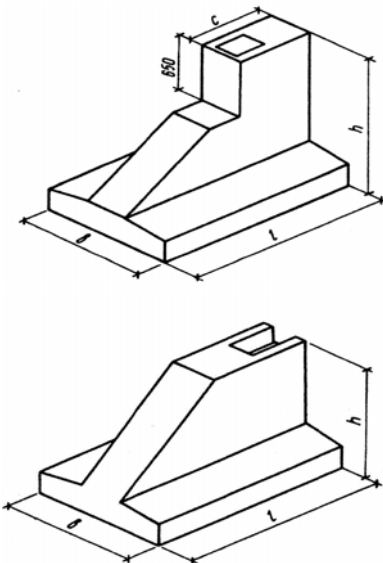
Конструктивне рішення фундаментів на палях-колонах:
